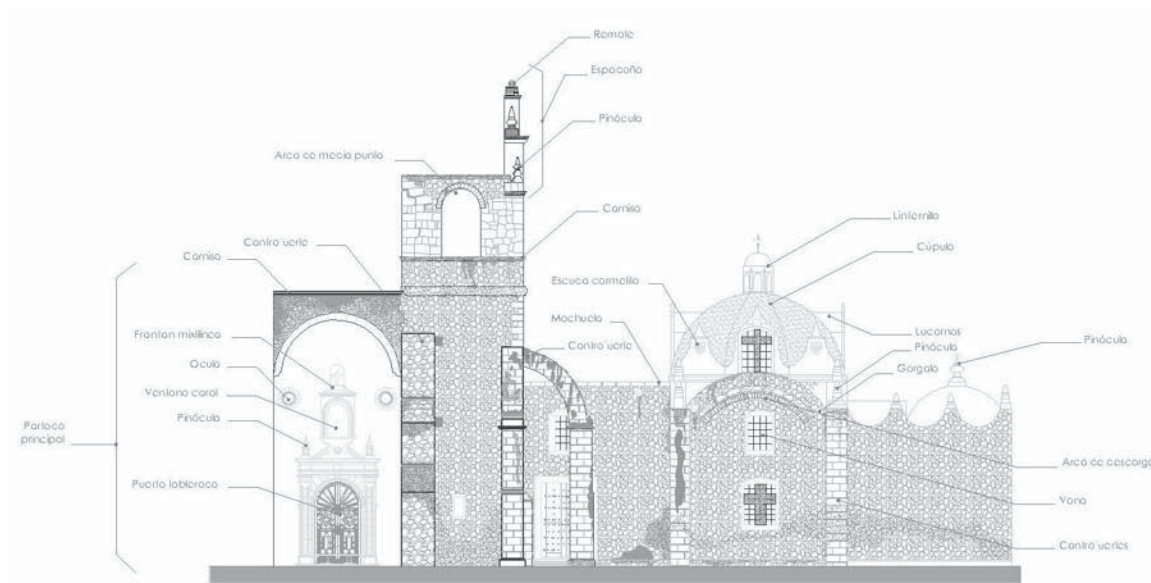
Fachada Principal, plano elaborado por Yadira C. Avila
